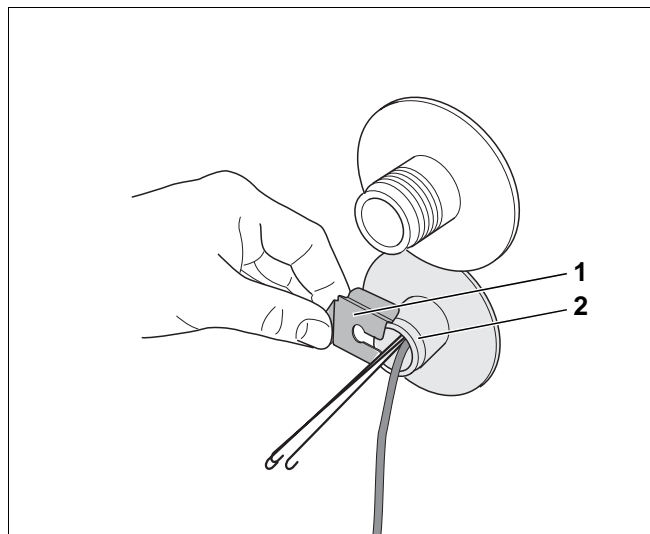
Montaggio dell'arresto di sicurezza della sonda
